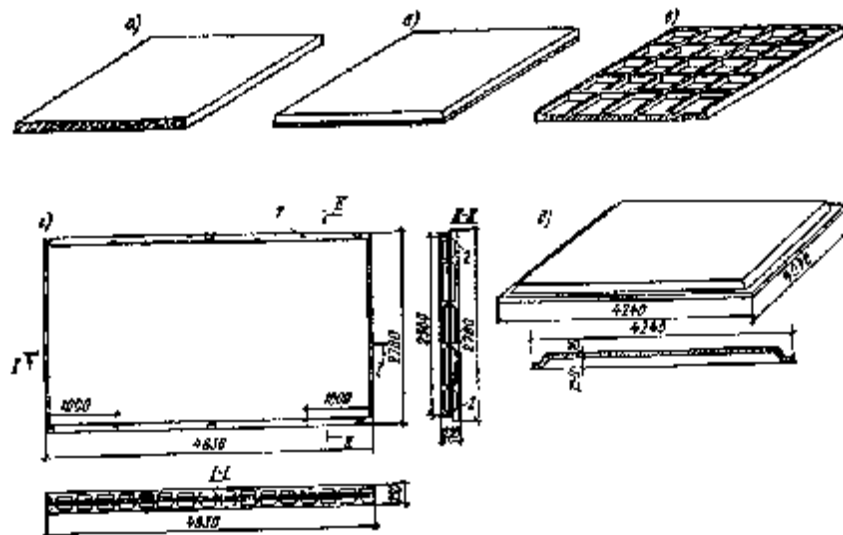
Сборные железобетонные панели перекрытий: а – сплошная однослойная; б – сплошная двухслойная; в – часторёбристая с ребрами вверх; г – то же, из двух вибропрокатных скорлуп; д – шатровая с ребрами по контуру; 1 – монтажная петля; 2 – звукоизоляционная прокладка.
